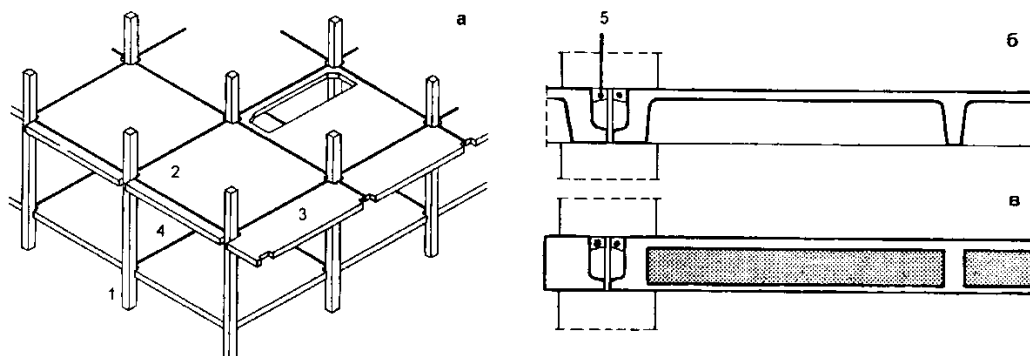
Безригельный каркас ИМС (бывш. Югославия): а - общий вид; б - вариант с ребристыми плитами; в - вариант с пустотно-замкнутыми плитами; 1 - колонна; 2 - рядовая плита; 3 - консольная плита; 4 - бортовой элемент; 5 - арматура натяжная
